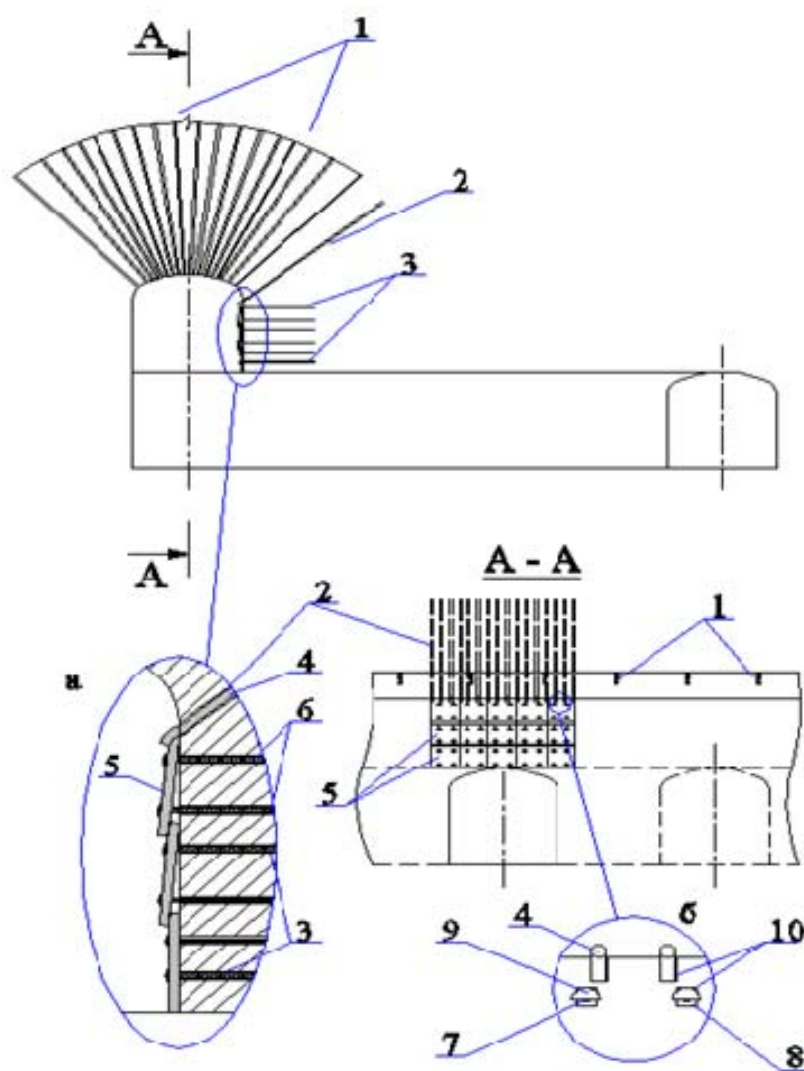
Схема футеровки рудоската и лобовины, соответственно, трубами и металлическими листами: 1– взрывные скважины; 2 – скважины для армирования трубами; 3 – шпурсы; 4 – трубы; 5 – металлический лист; 6 – анкера; 7 – «замок»; 8 – пятка анкеров; 9 – защитные пластины; 10 – сварной шов
